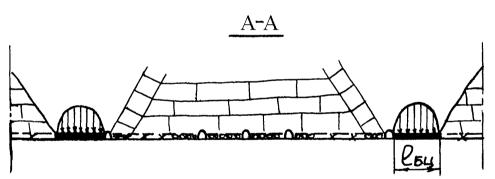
Охрана наклонных выработок, проводимых вслед за разгрузочной лавой, бутовыми полосами.
